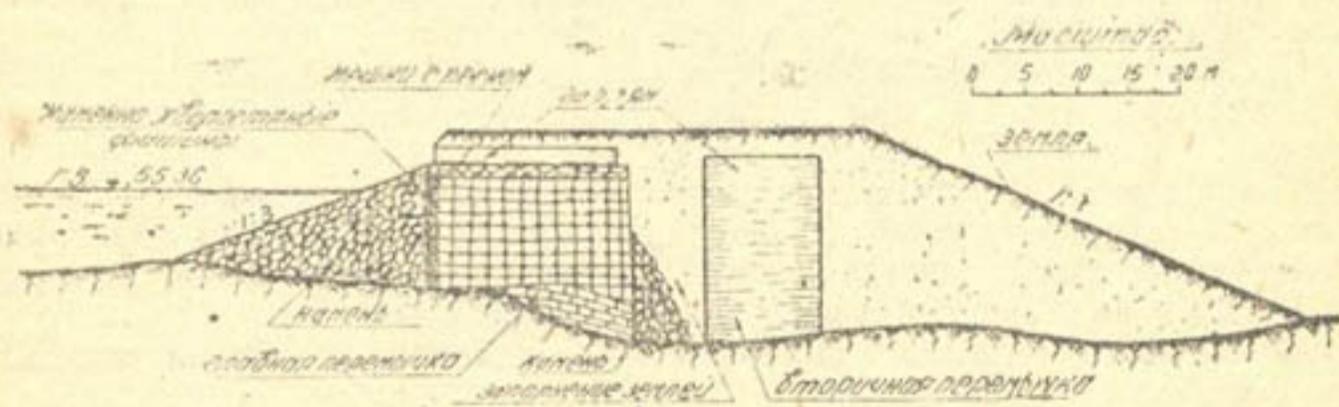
Перемычка после окончания работ по перекрытию прорыва
